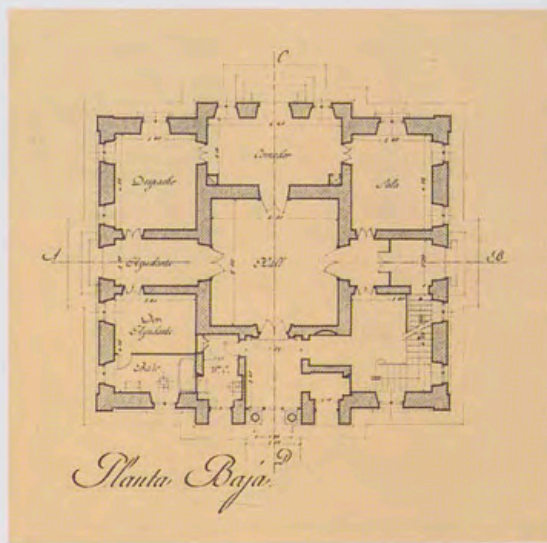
Diego Méndez (copia), Proyecto para la reforma de la Casa de Arriba. Detalle: planta baja, acotada. Madrid, octubre de 1941. Archivo General de Palacio, Planos, nº 8853, Patrimonio Nacional.
